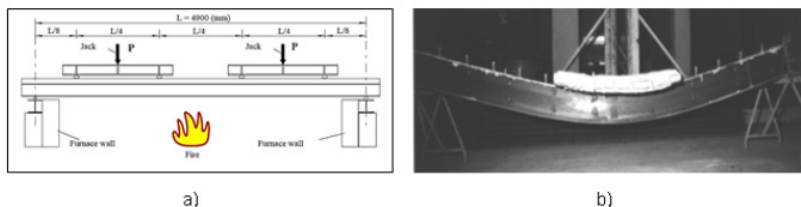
Viga compuesta de acero y hormigón. a) Esquema general de ensayo en situación de incendio. b) Viga deformada después del ensayo. Fuente: Kruppa y Zhao (1995)
